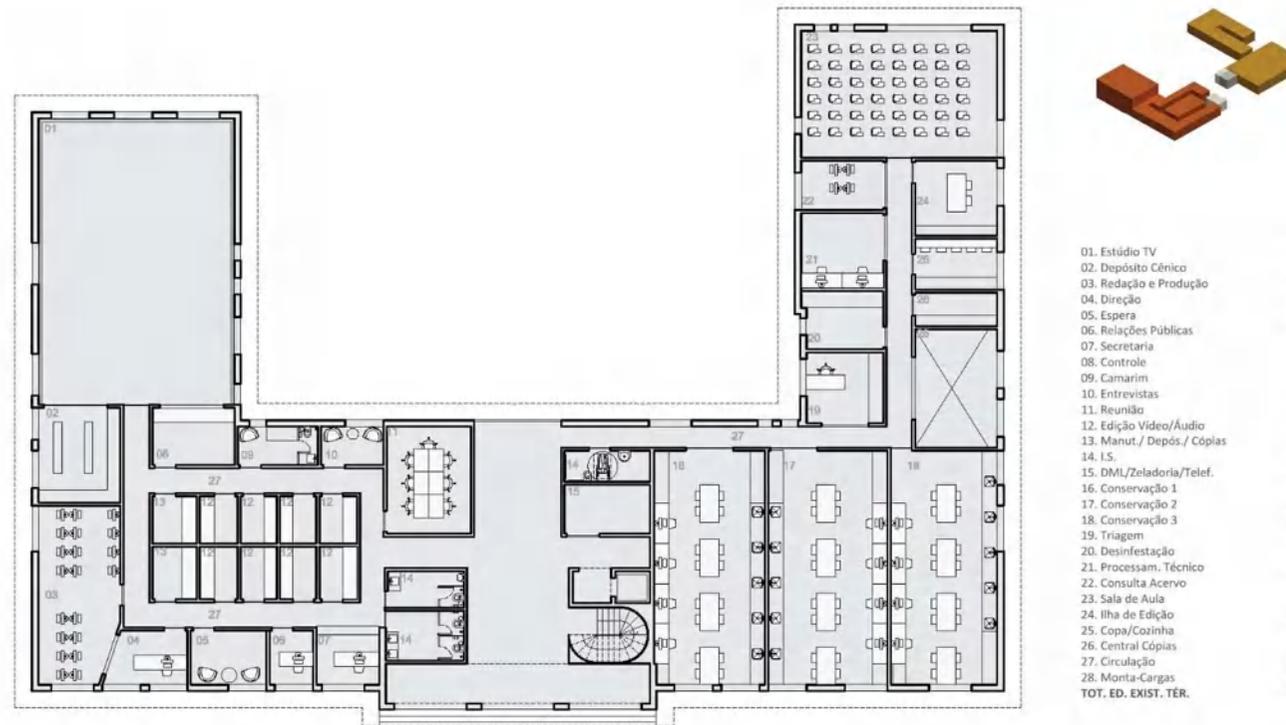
Planta baixa do pavimento térreo do novo bloco Campus Cabral – UFPR (sem escala)
